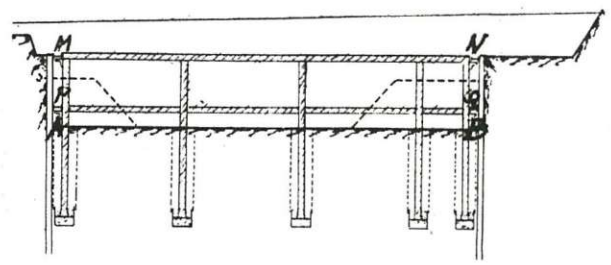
a) Enlèvement des déblais suivant A B; b) Achèvement de la pose de l'ossature métallique du plafond du tunnel et calage en P et Q de cet étaisonnement contre les rideaux de palplanches.
